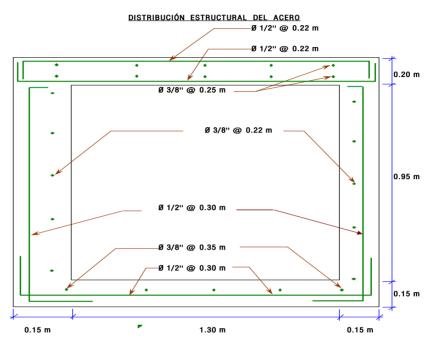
Vista de la sección de la alcantarilla según los planos del expediente técnico
